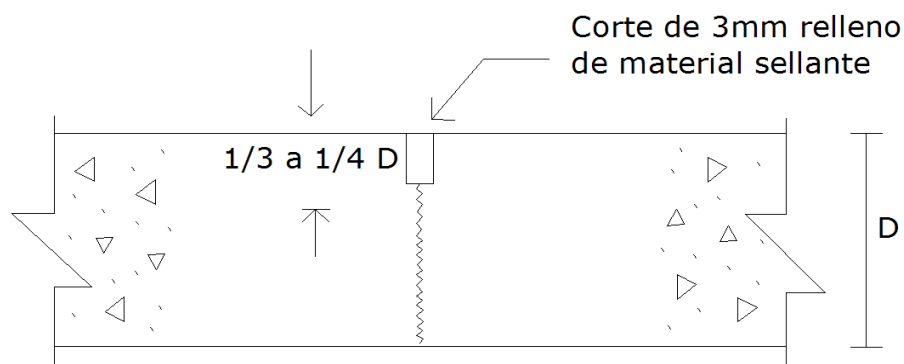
Juntas de contracción para pavimentos rígidos.
